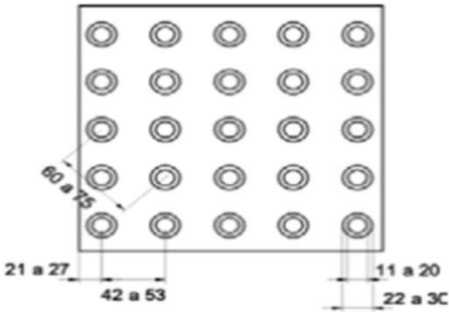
Sinalização tátil de alerta - Modulação do piso
